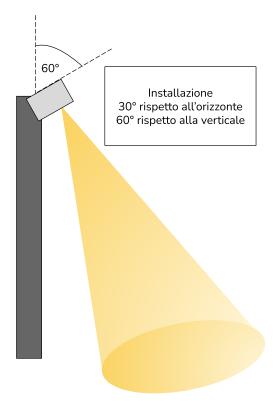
Installazione KiwiZone - Gate Inside/Outside
